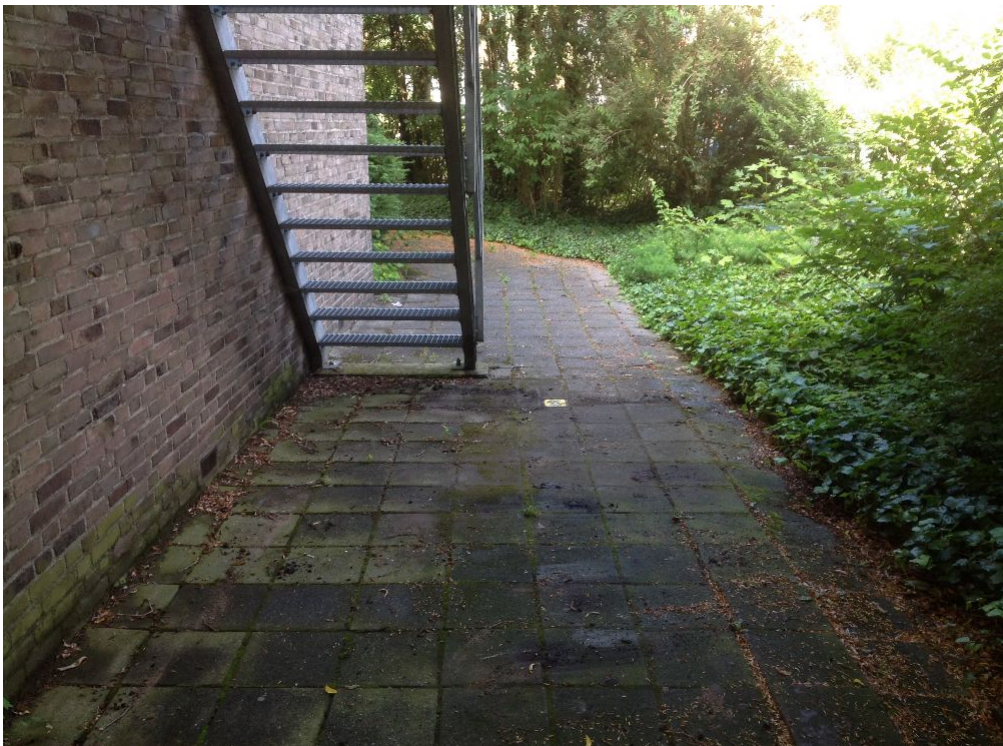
Zijkant kerkgebouw gezien in noordoostelijke richting.
